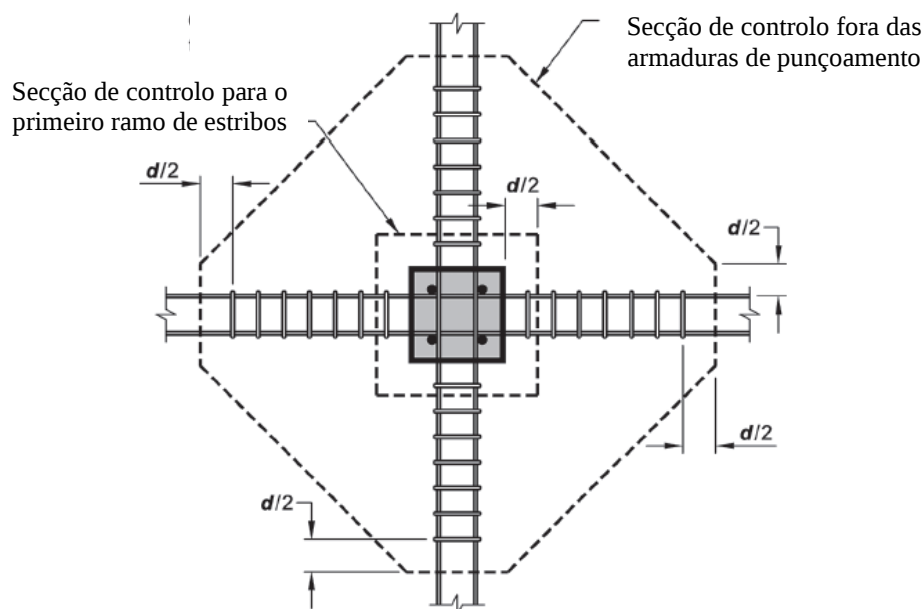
Secção de controlo de punçoamento para pilares interiores e respetiva disposição da armadura (Adaptado de ACI 318-14, 2014)
